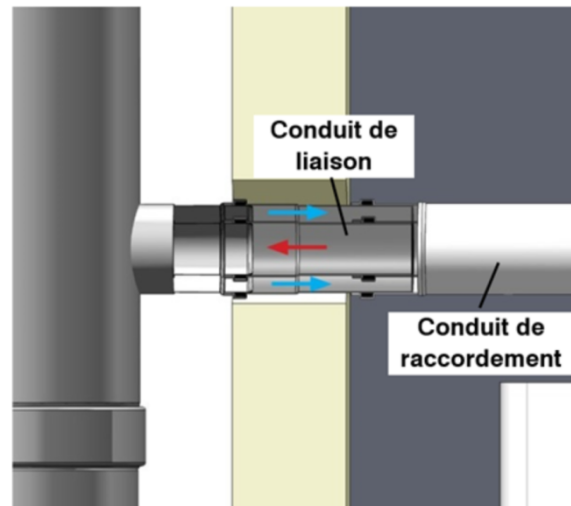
Mise en place du conduit de liaison, version DINAGAS 3CE+ à l'intérieur d'un bâtiment
